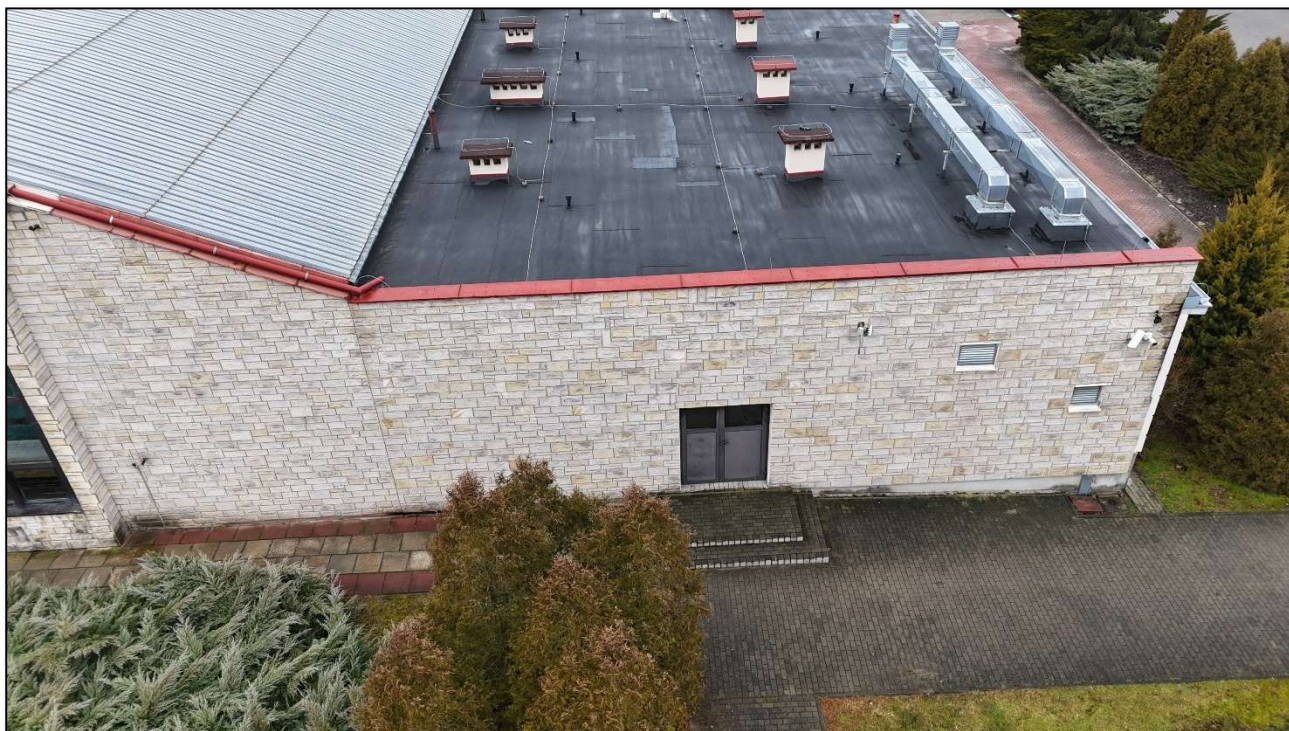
Detal płaszczyzny dachu. Analiza przyczyny w treści opracowania. (fot. Rafał Fit)
